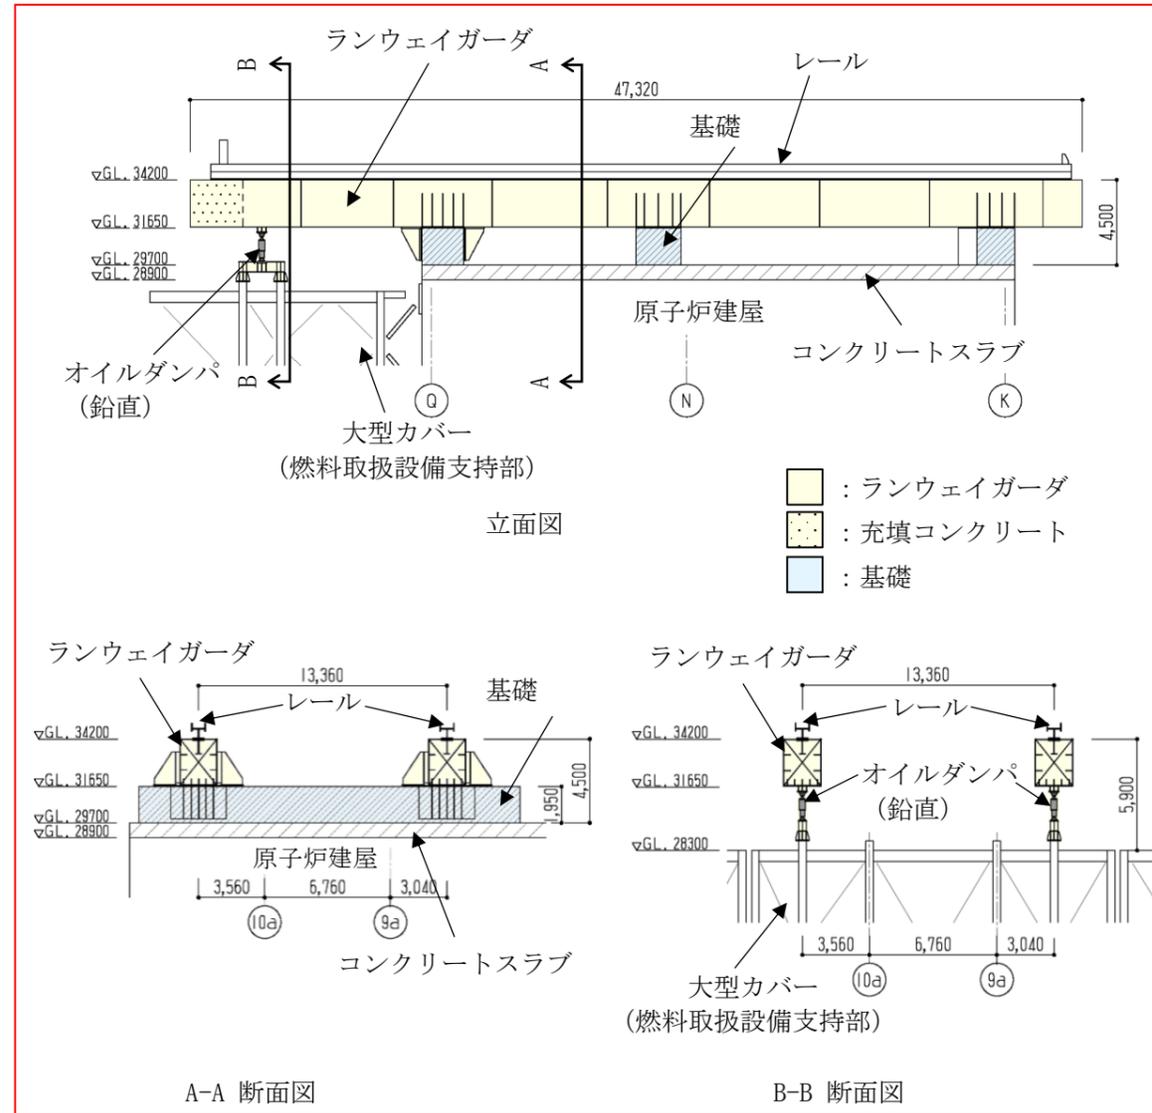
ランウェイガーダの概要図 (単位: mm)
